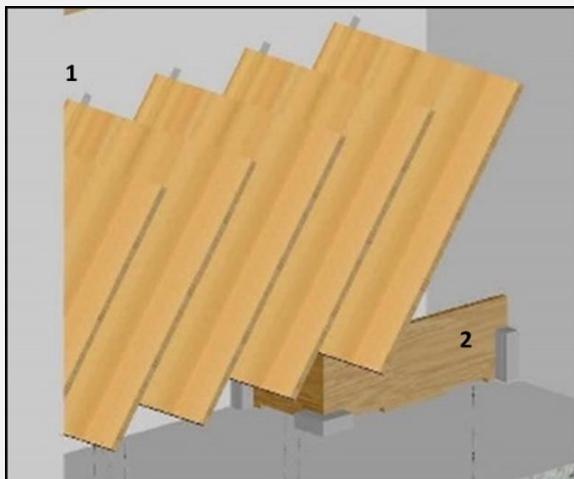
Rainures sur la planche, tournées vers le bas
